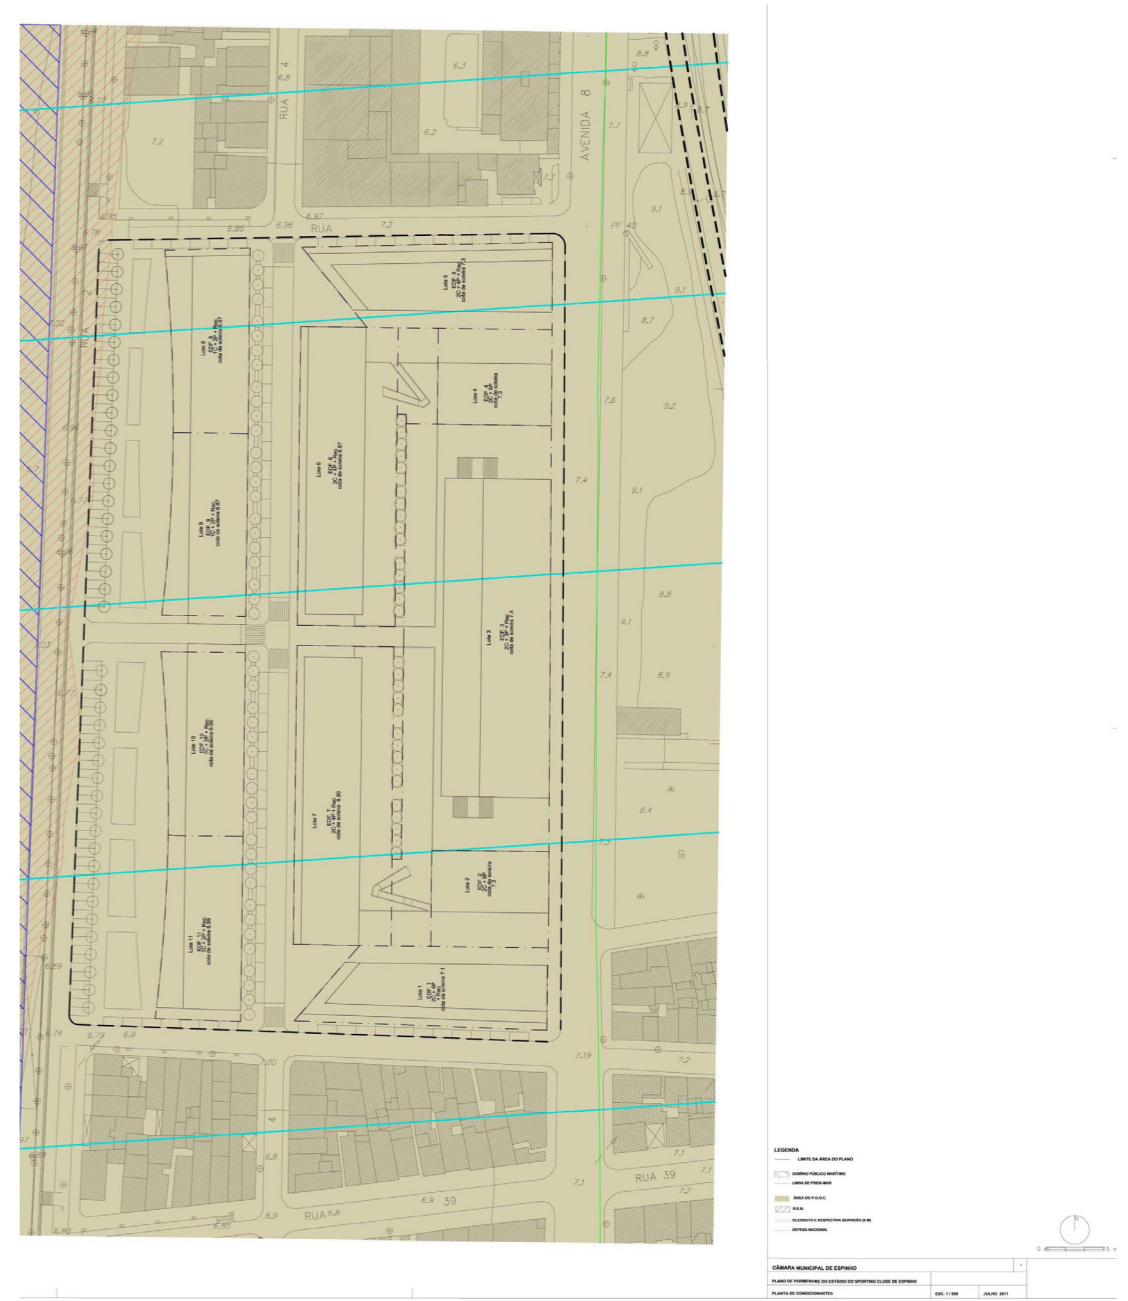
Planta de condicionantes Plano Pormenor do Estádio do Sporting Clube de Espinho. Câmara Municipal de Espinho.
